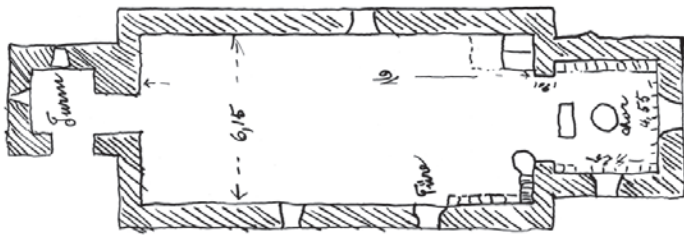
Biel-Mett, Kirche. Grundrisssskizze der Kirche Mett von Pfarrer Ludwig Gerster, 1892. M. ca. 1:300.
